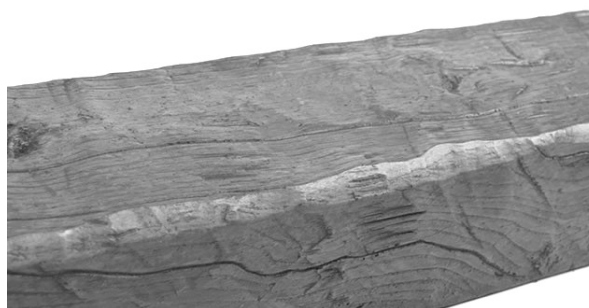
Exemplo de viga de madeira folhosa (castanho).
